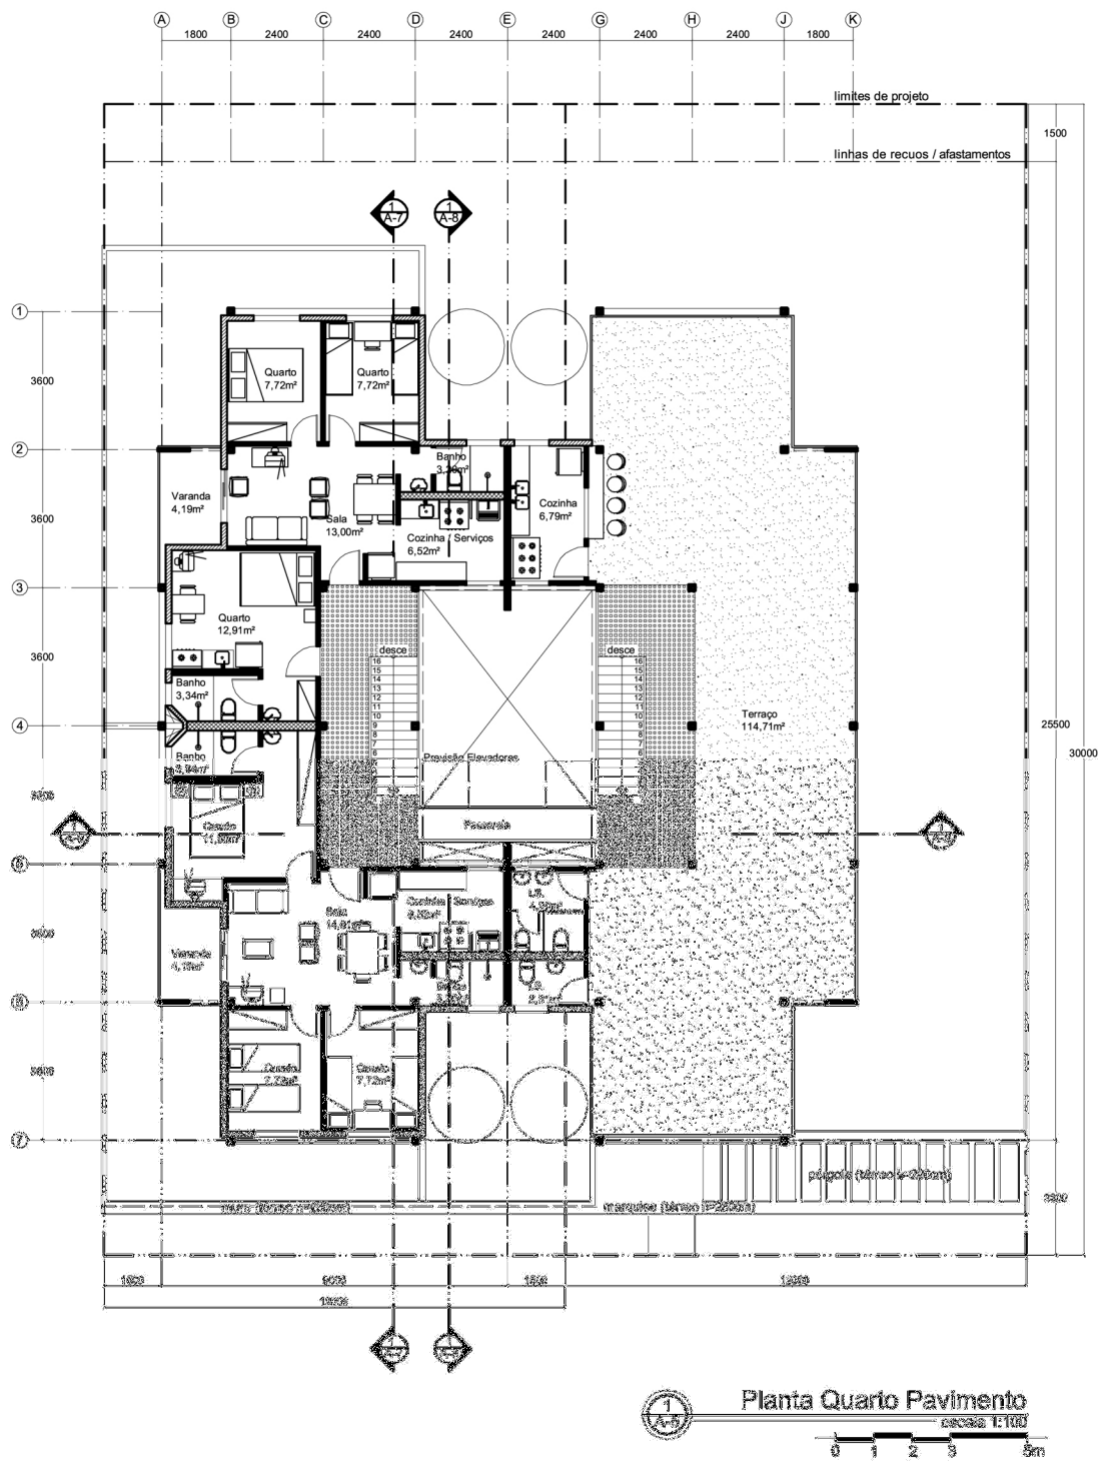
Planta quarto pavimento. Fonte: Arquivo do autor
